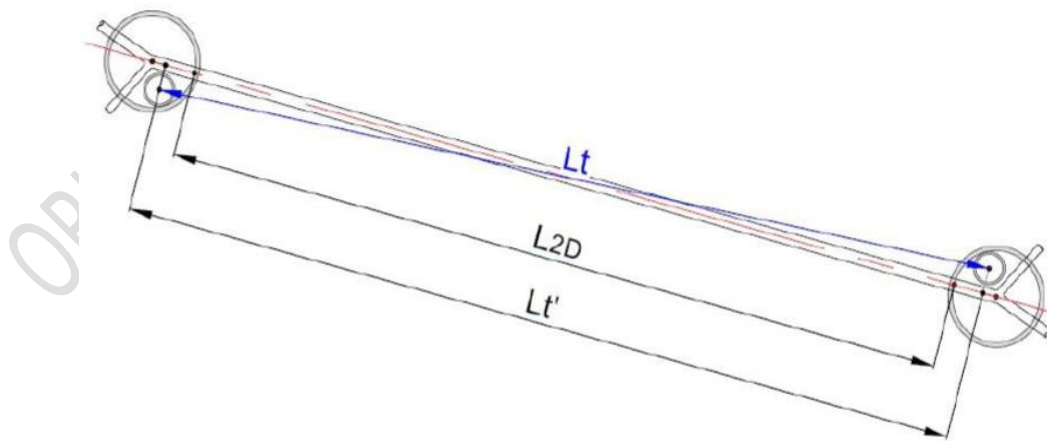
Detalle en planta para el cálculo de la longitud de la tubería.
